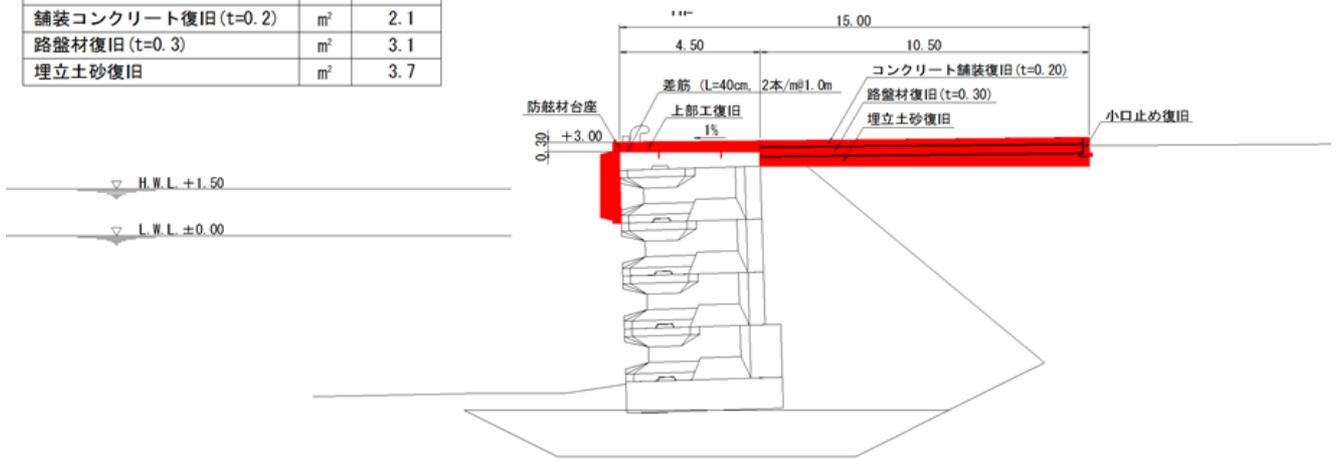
249 No.22 常陸那珂港区_南埠頭地区 B岸壁 (-5.5m) の断面図 (復旧後)
